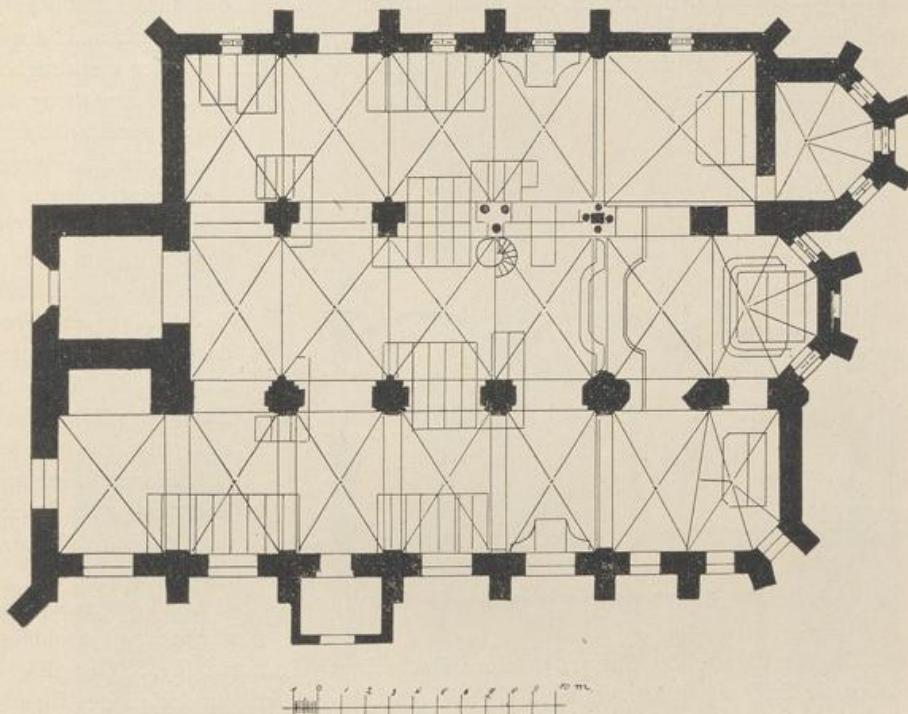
Anrath. Grundriss der katholischen Pfarrkirche.
